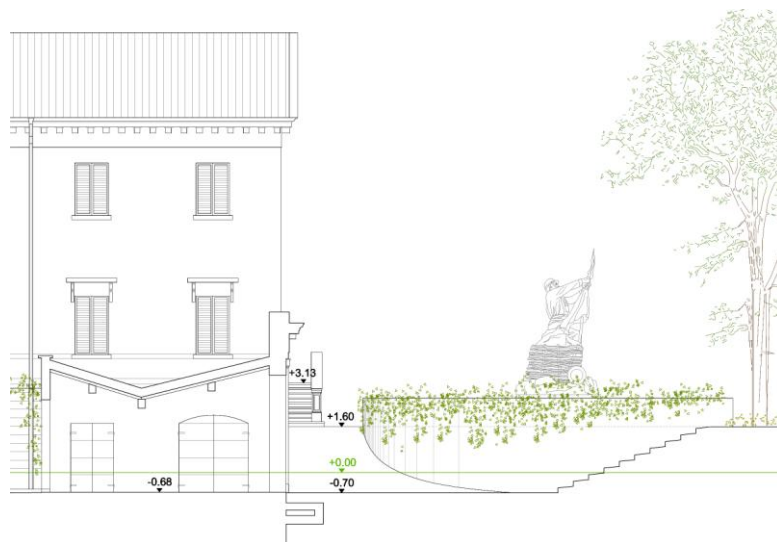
sistemazione del terreno dopo l'intervento di restauro
